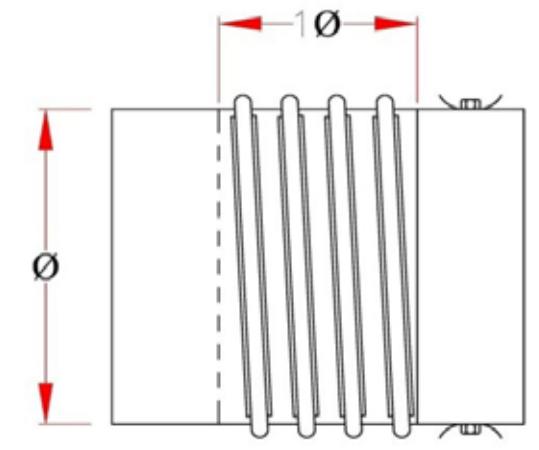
Manguito conector a Cámara Hormigón-Espiga
